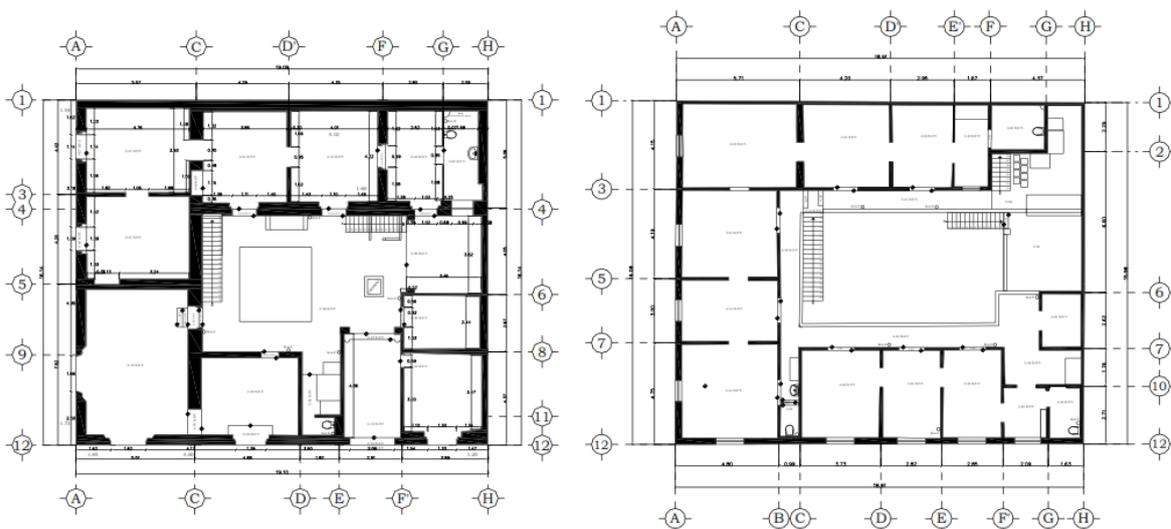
Primeros planos obtenidos del proyecto (planta baja y planta alta)
